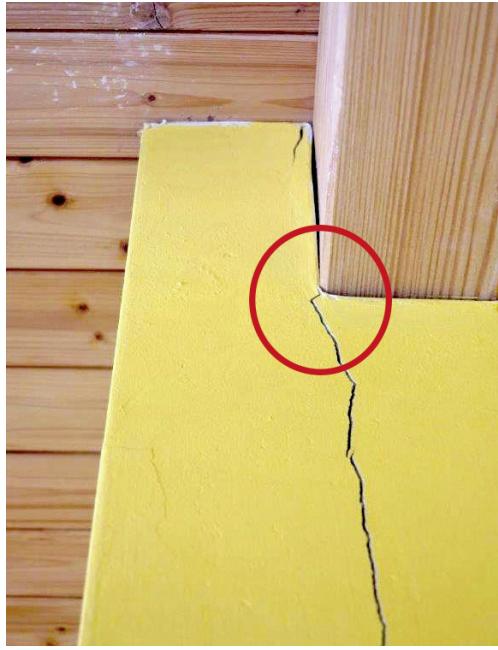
■ Rissbildung im Mauerwerk durch trocknungsbedingte Verformung (Hohlziehen) des Deckenbalkens aus Konstruktionsvollholz (KvH)
